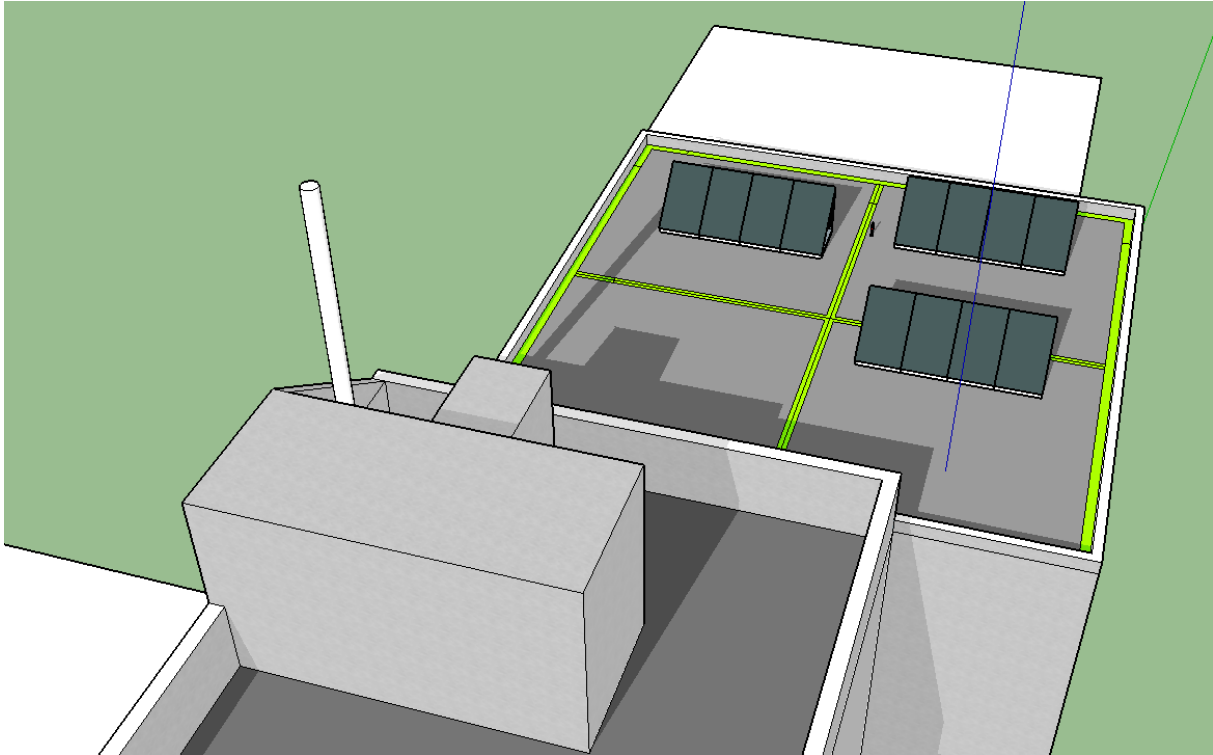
Verschattungsstudie des Daches mit den PVT-Kollektoren. Dargestellt ist die finale Belegungsplanung mit drei Strings zu je vier Kollektoren.
